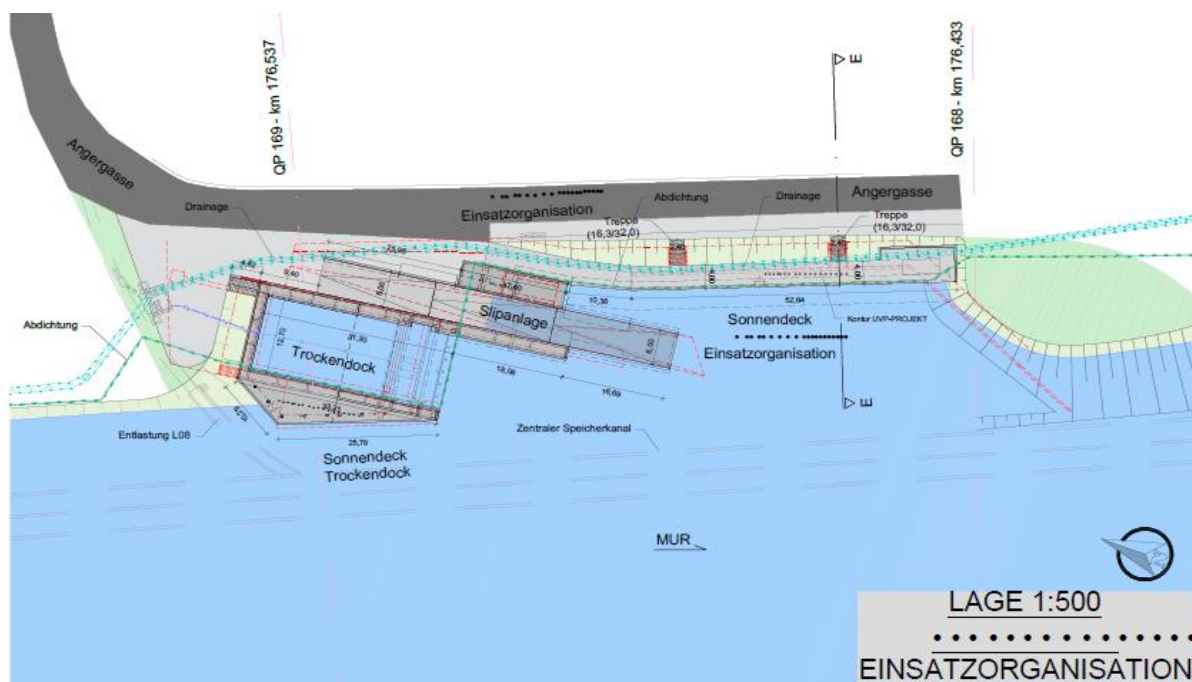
Lageplan Slipeinlage/Stützpunkt Einsatzorganisationen Ausführung (aus KOL\_LP\_SCH\_Sonnendecks\_Teil1\_20241217)
